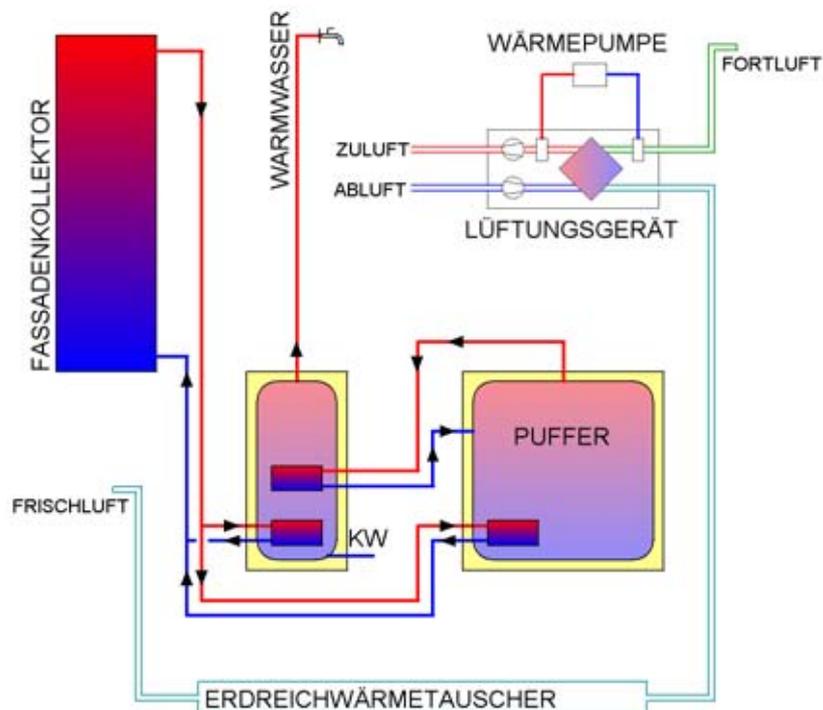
Schemazeichnung der Haustechnik mit Wärmepumpe
